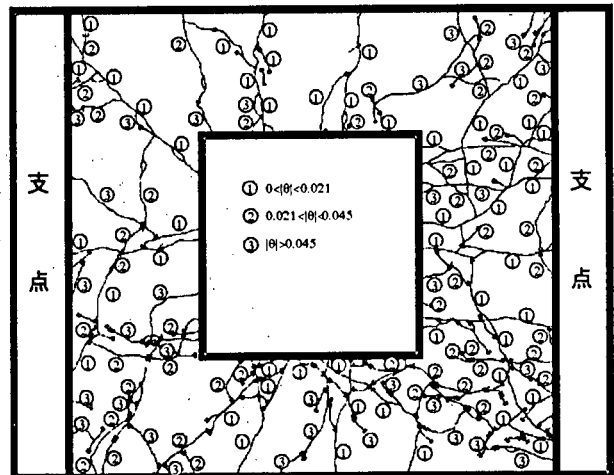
繰り返し載荷時のひび割れ状況
